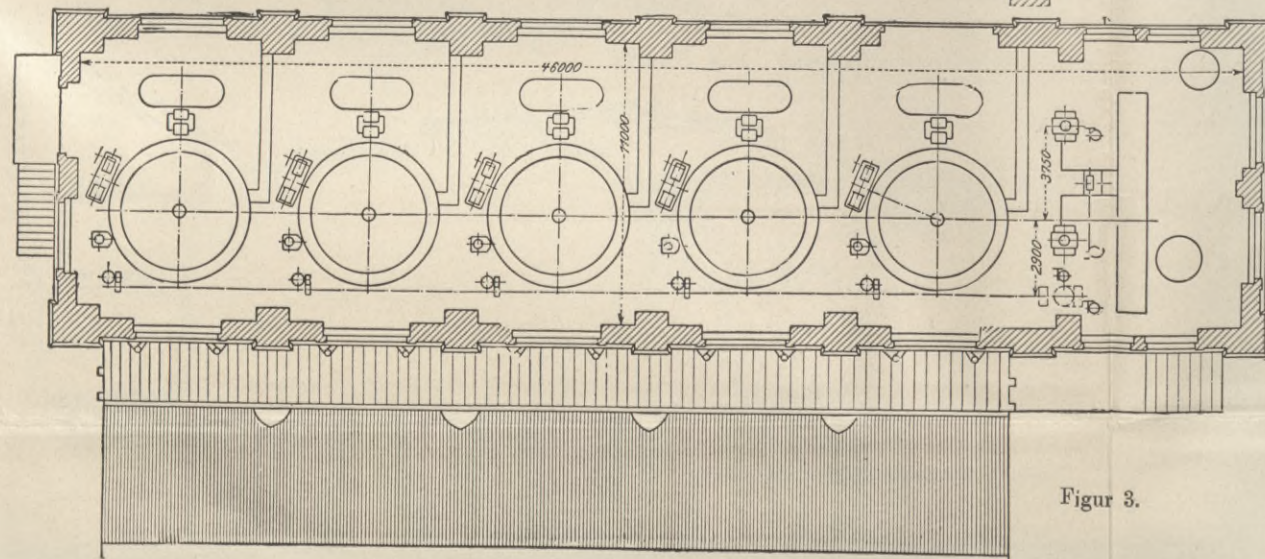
, 2 und 3. Grundrisse und Längsschnitt durch das Krafthaus. 1 : 300.
